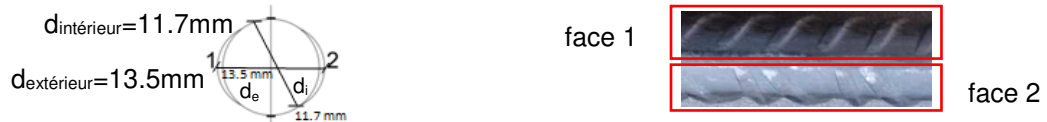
a) Section transversale d'armature en acier ; b) Faces 1 et 2 d'armature en acier
